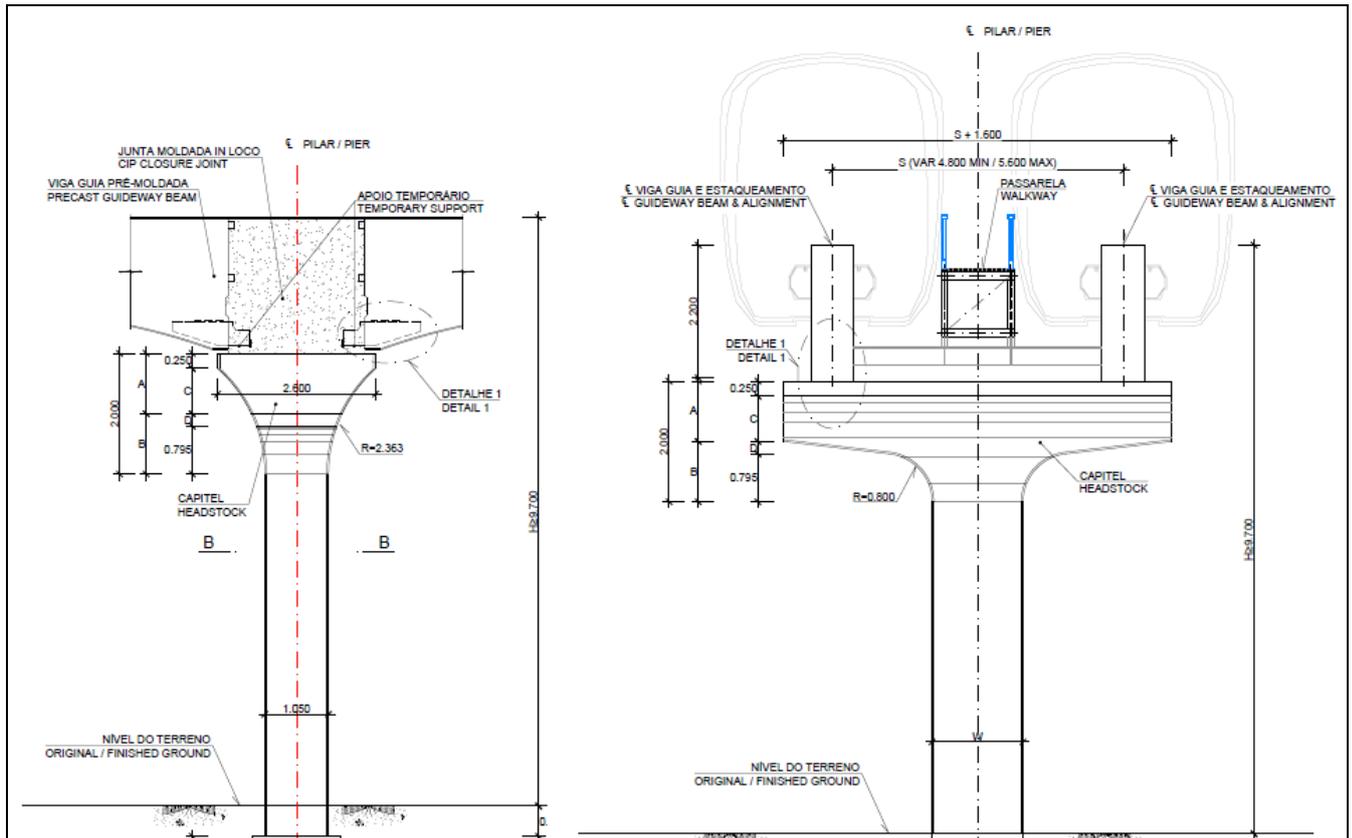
Forma Estrutura Via Elevada Tipo 1B (Planta DE-MG.00.EL_C.EC2-008).
